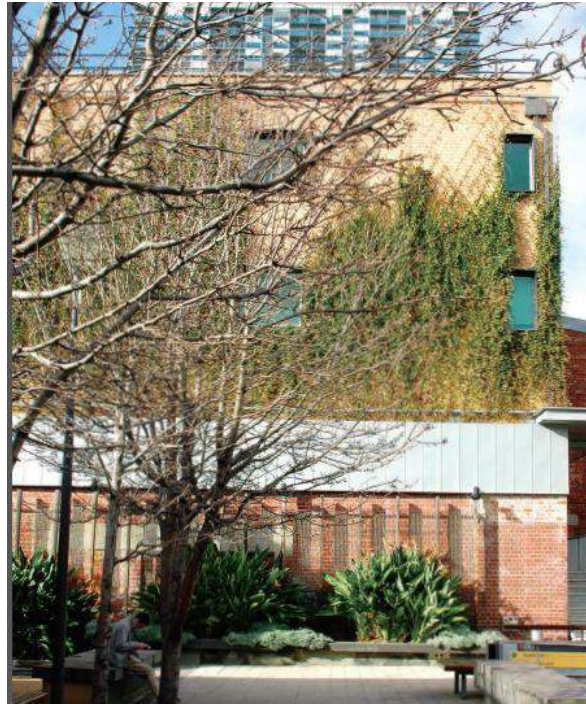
VISTA DAS ESTRUTURAS DE AÇO GALVANIZADO, ONDE OCULTAM AS CAIXAS DE PLANTAÇÃO E O SISTEMA DE IRRIGAÇÃO.
